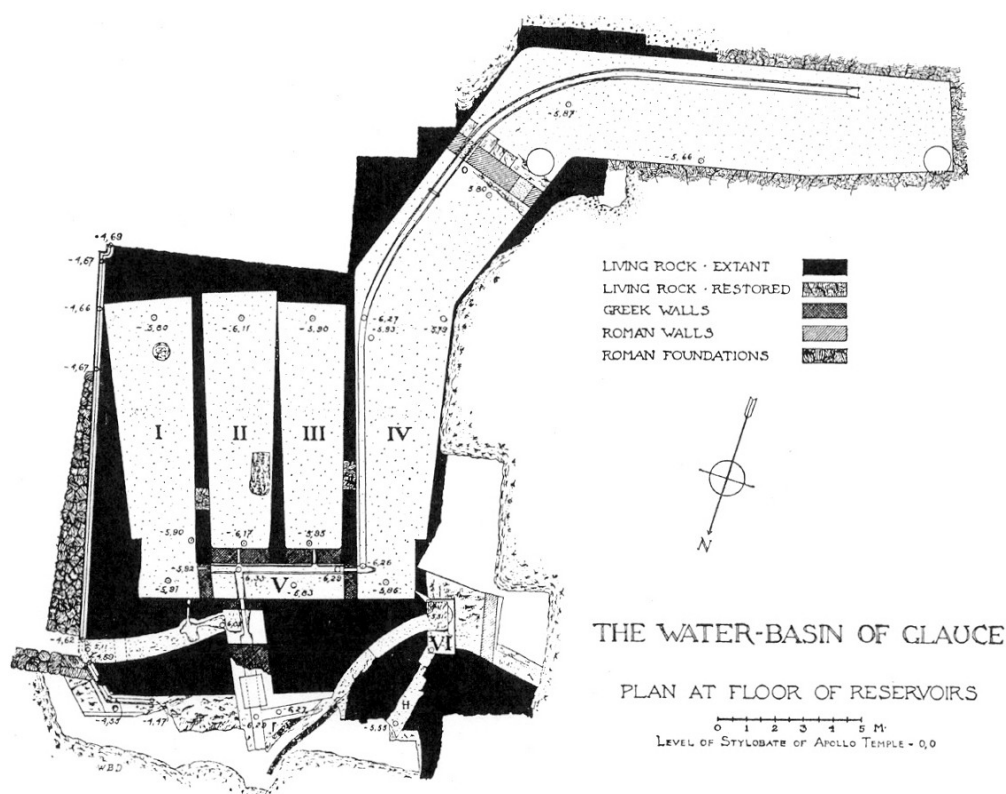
Fuente Glauco. Planta de la fuente y de los aljibes
